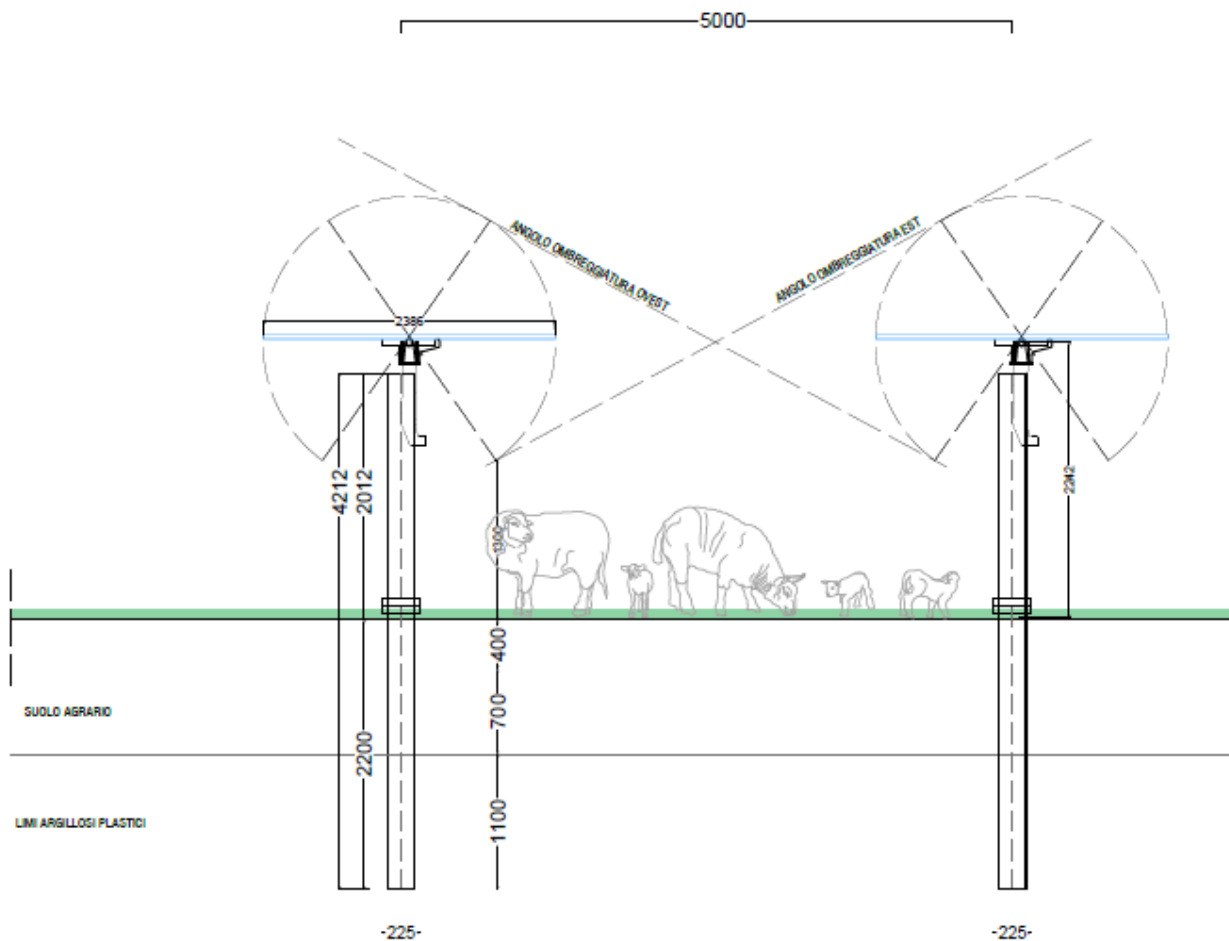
Sezione trasversale stringhe in area attività zootecnica.
